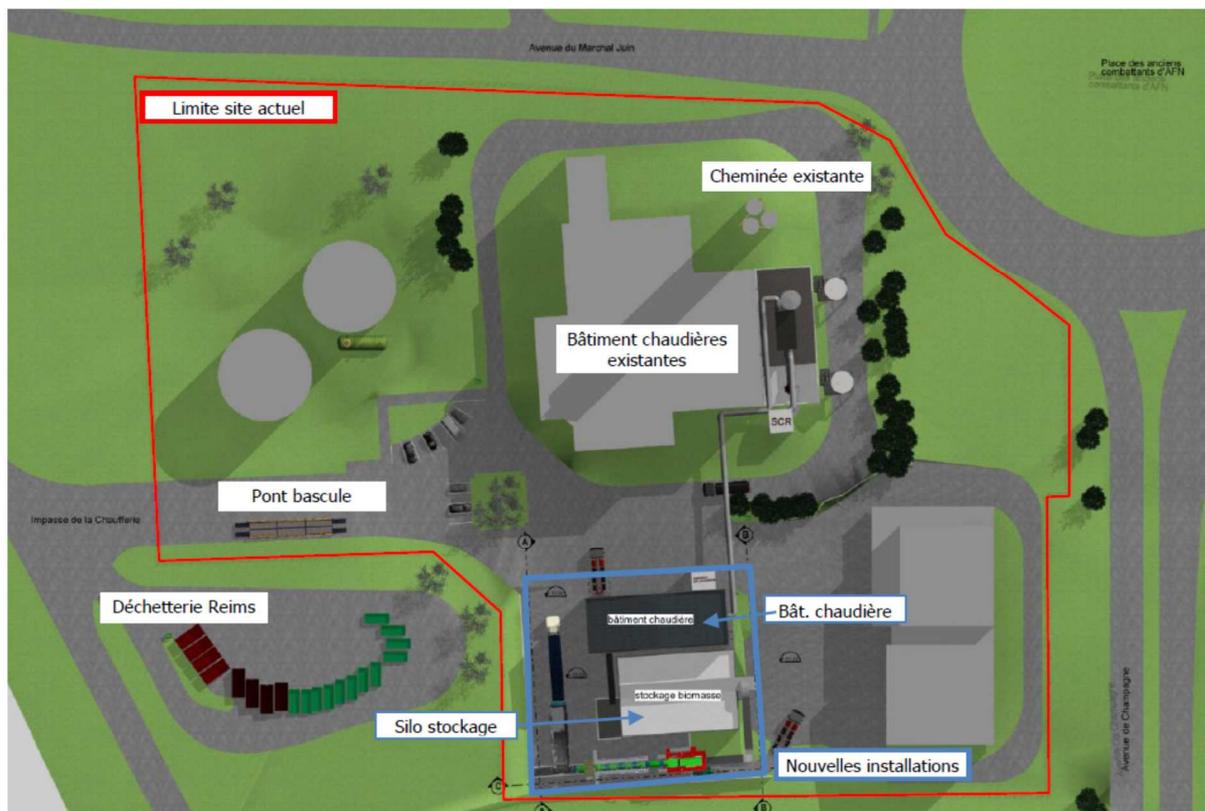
VUE EN PLAN DE L'INTEGRATION DU PROJET SUR LE SITE SOCCRAM.
